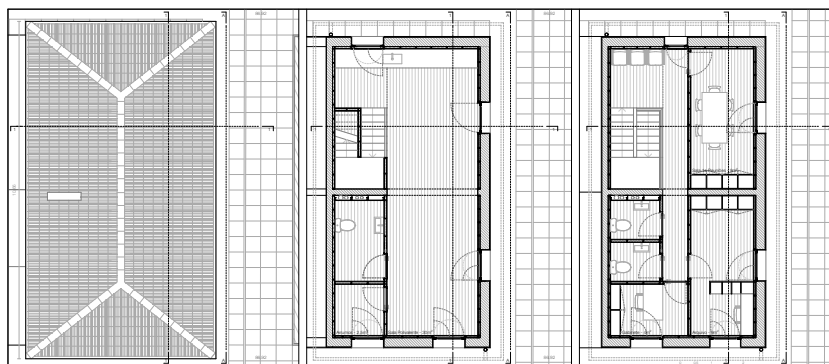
Planta de Coberturas; Planta de R/C; Planta de 1º Piso. Desenhos 35B, 36B, 37B, Volume II
